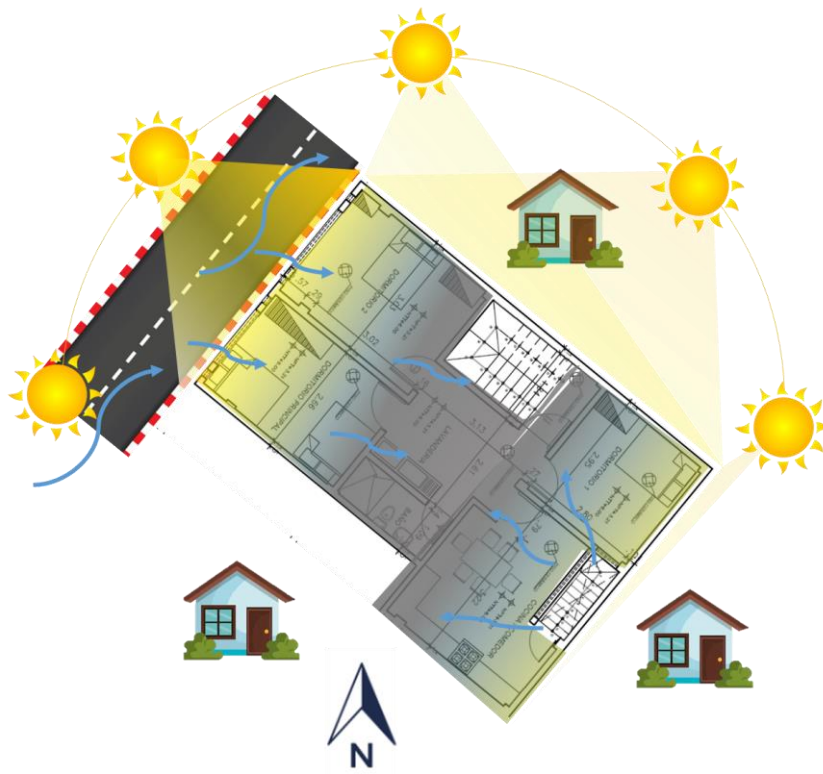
Plano de la vivienda FB – Nivel 2do piso
